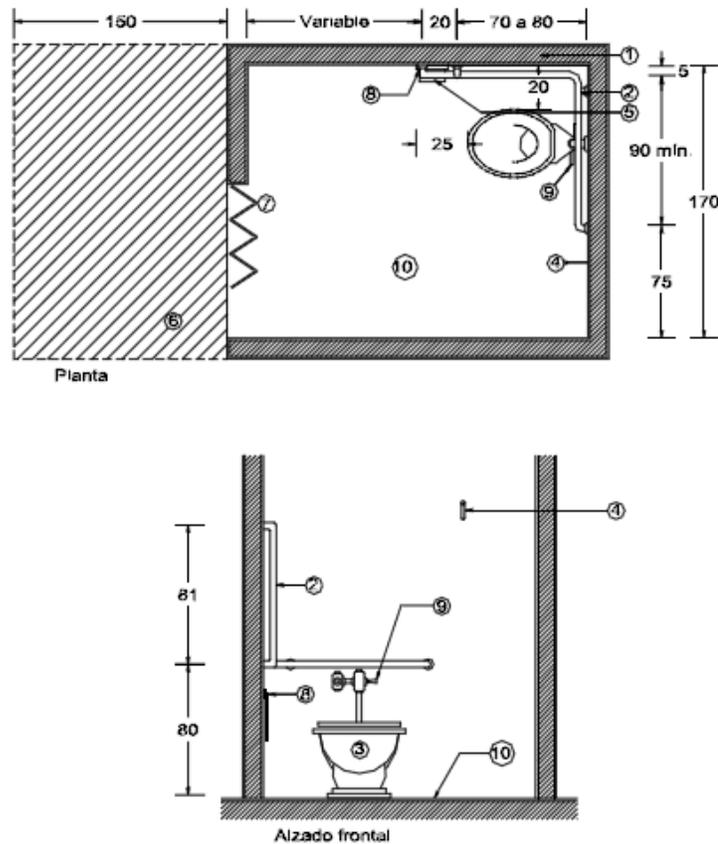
Planta y alzado de un baño con medidas para una persona en silla de ruedas.
